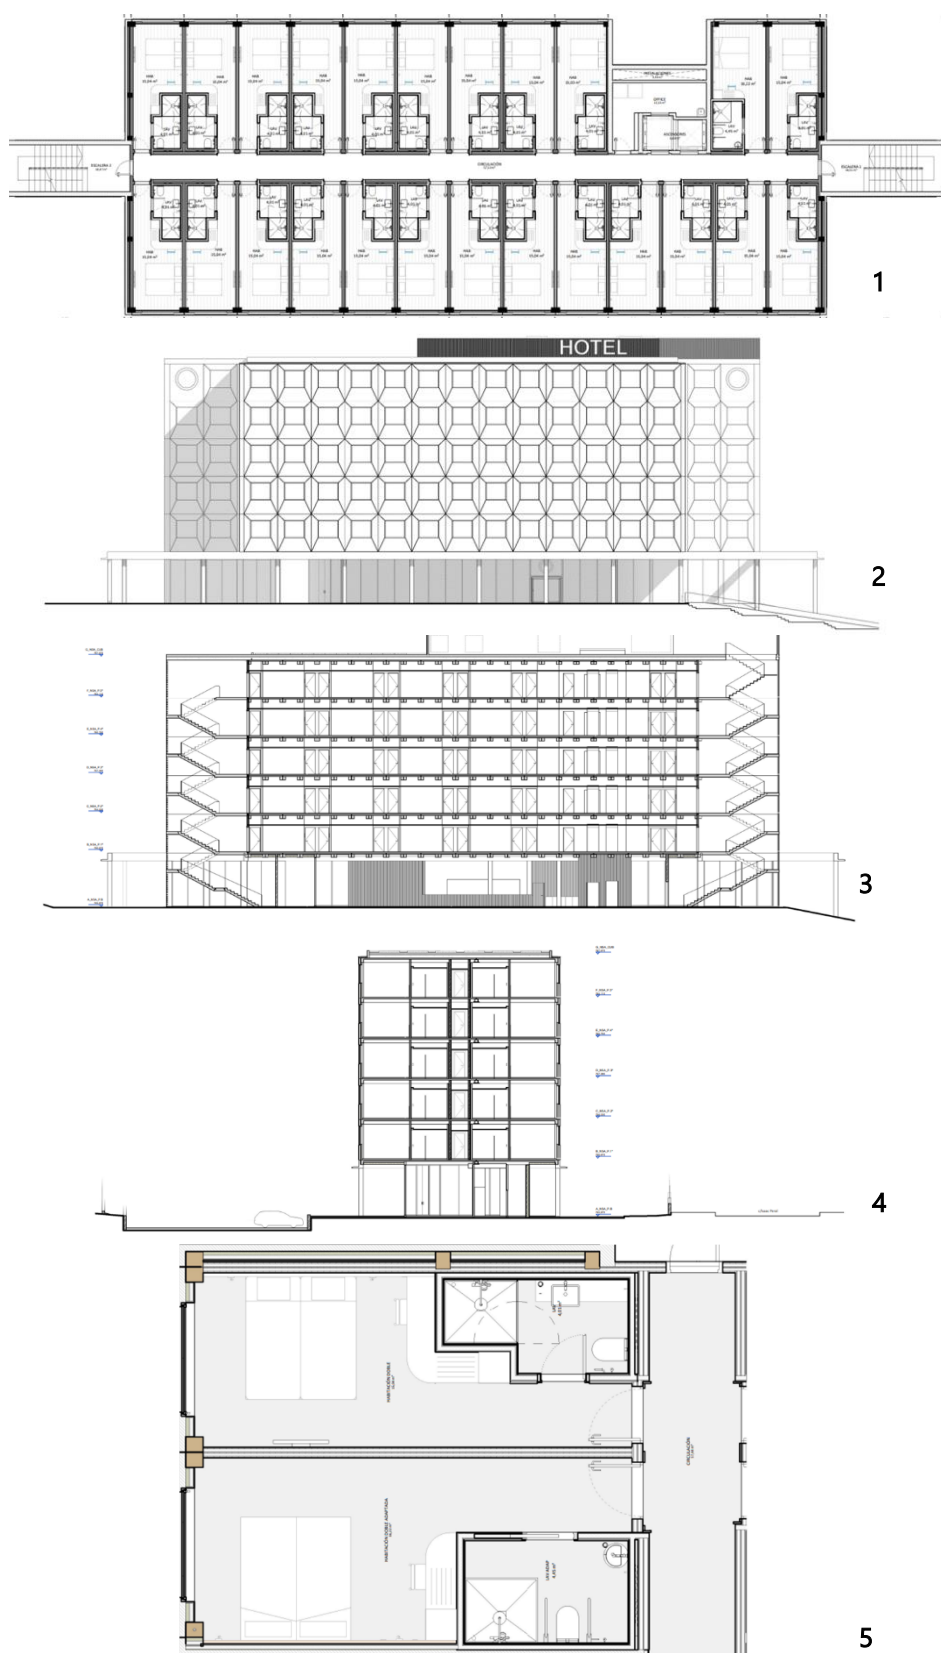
Caracterização do Hotel: 1- Planta pisos elevados; 2- Alçado principal; 3- Corte longitudinal; 4- Corte transversal; 5- Planta de quarto duplo simples e adaptado
